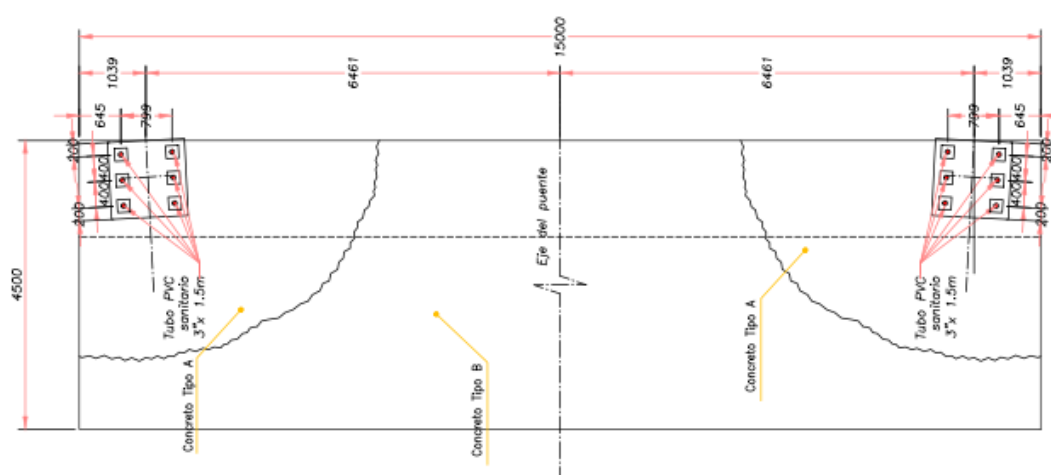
Vista en planta de cámara de anclaje de retenida de Puente
